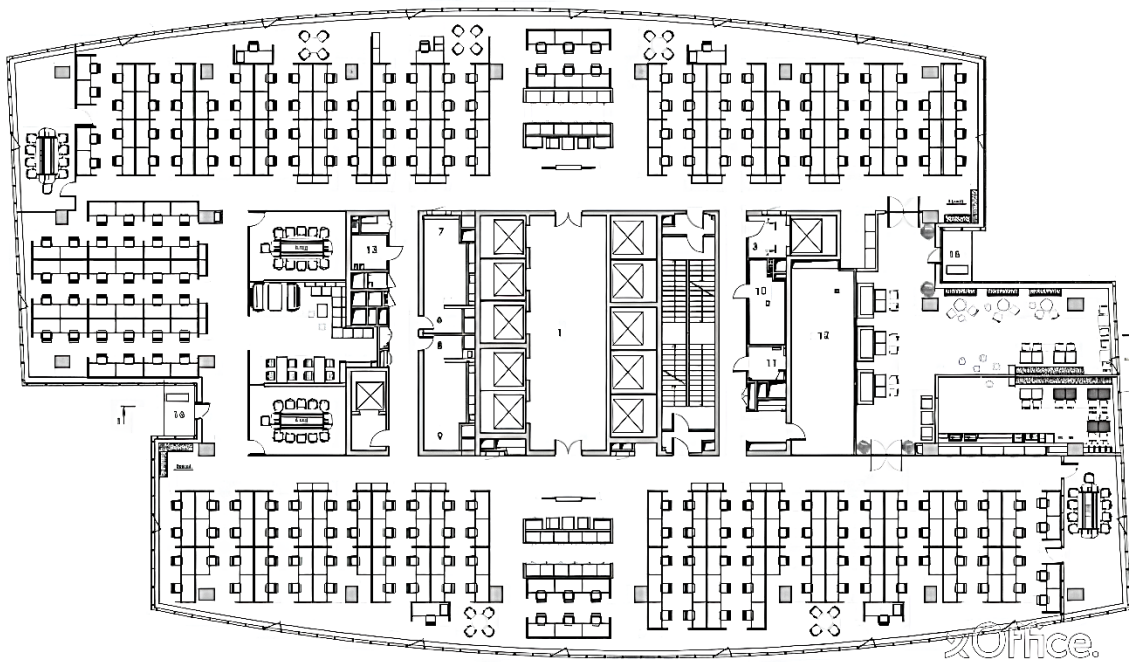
Планування типового поверху Бізнес-центру 101 Tower
